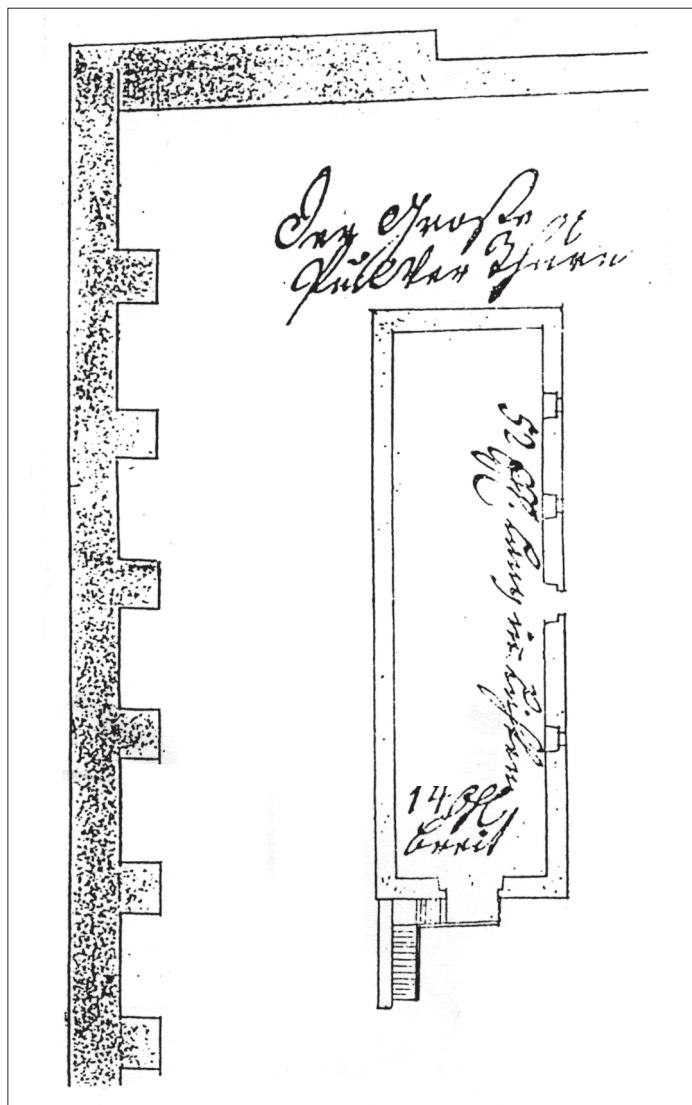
Prag 2-Vyšehrad. Vermessung der Südfront und Grundriss des Alten Burggrafenhauses, ursprünglich Palas von Karl IV. (Konskriptionsnr. 973), erstellt von K. Hilbert d.J. 1958.
